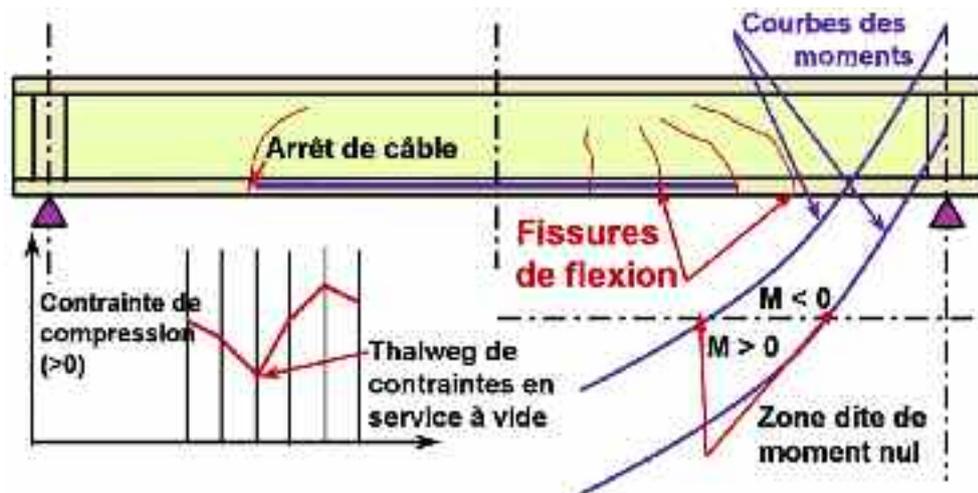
croquis des zones préférentielles de fissuration par flexion
